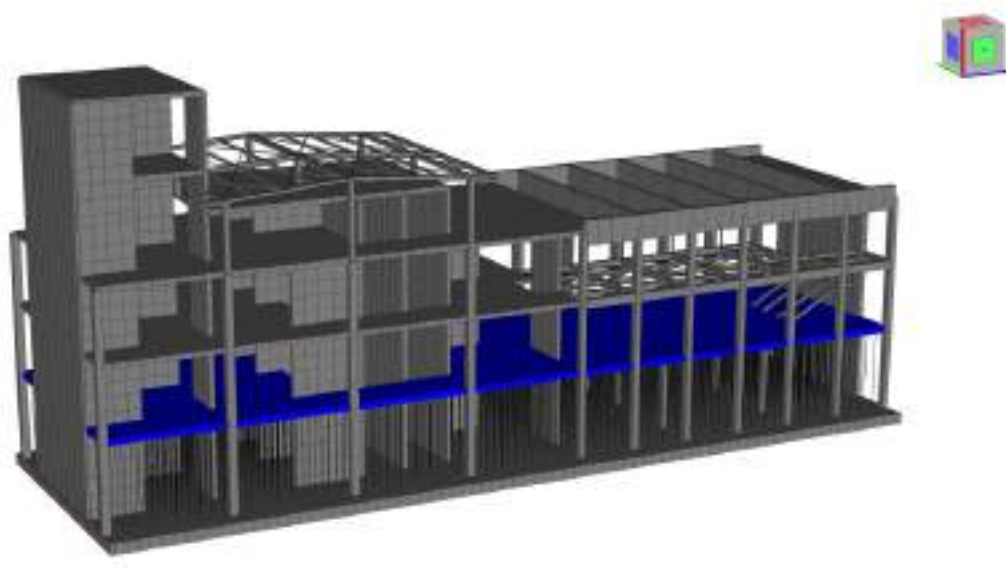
implementazione del carico pacchetto pavimentazione L0 – $g_k = 5.60 \text{ kPa}$.
